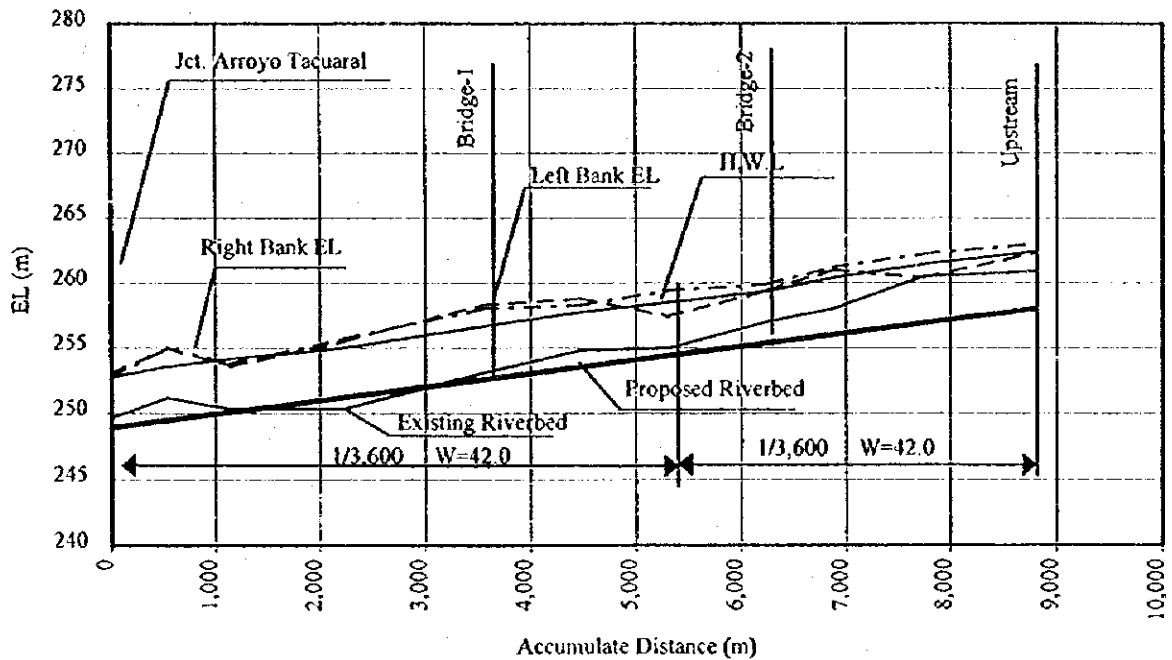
(4) PERFIL LONGITUDINAL DEL MEJORAMIENTO DE DRENAJE
